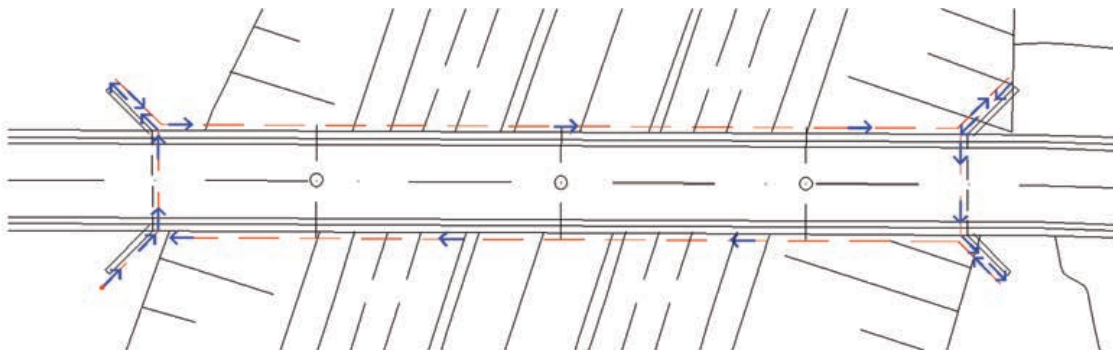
INSPECCIÓN PERIMETRAL INFERIOR.
